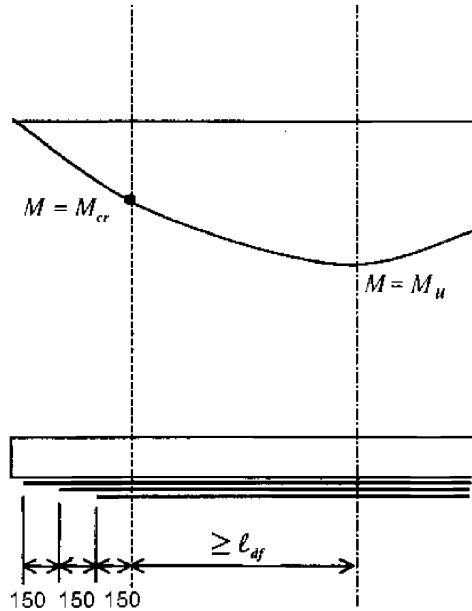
Схема анкеровки однопролетных железобетонных конструкций
